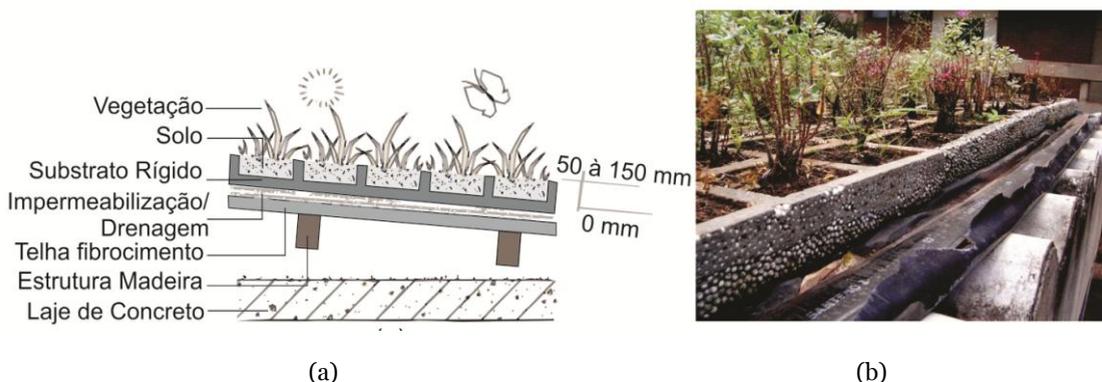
(a) Detalhe das camadas de telhado verde extensivo e (b) Telhado Vegetado extensivo em Cuiabá-MT/Brasil.
